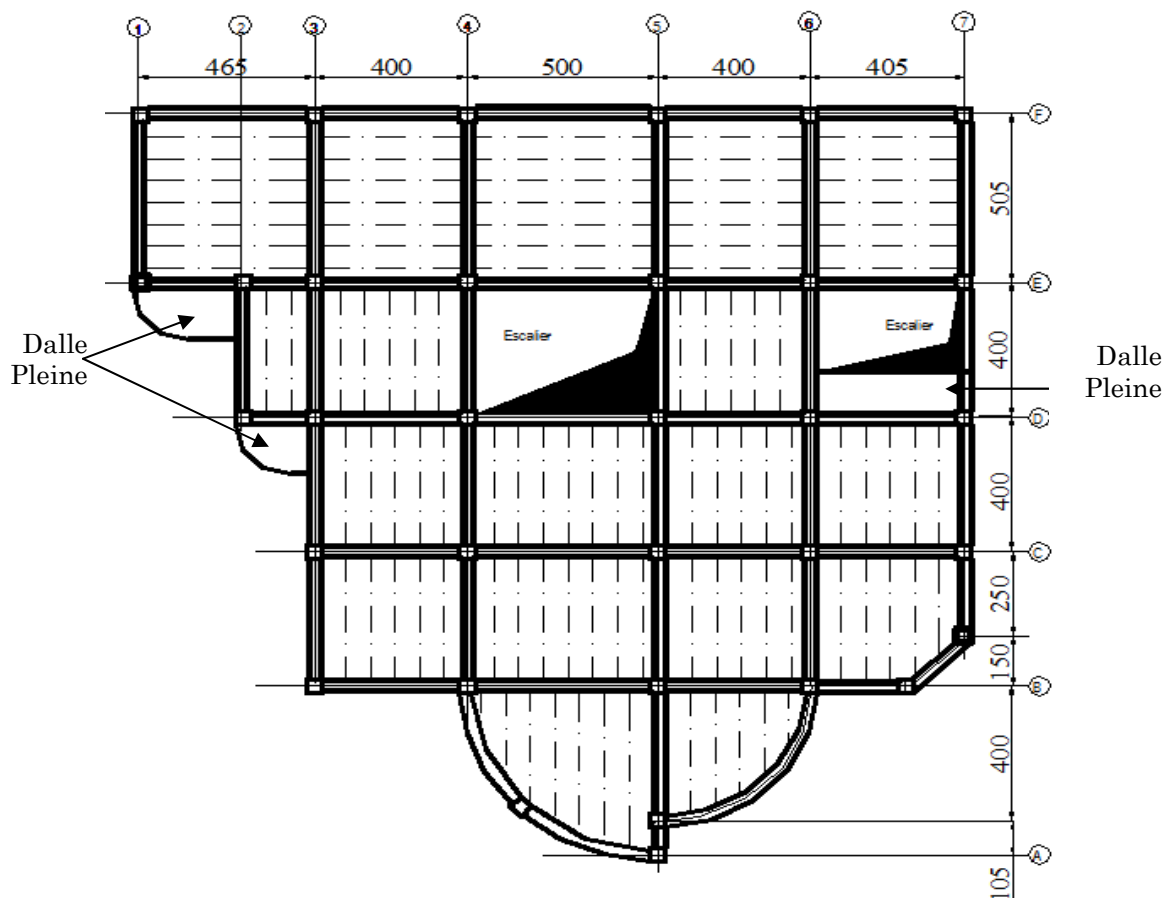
sens de disposition des poutrelles pour le bloc B
